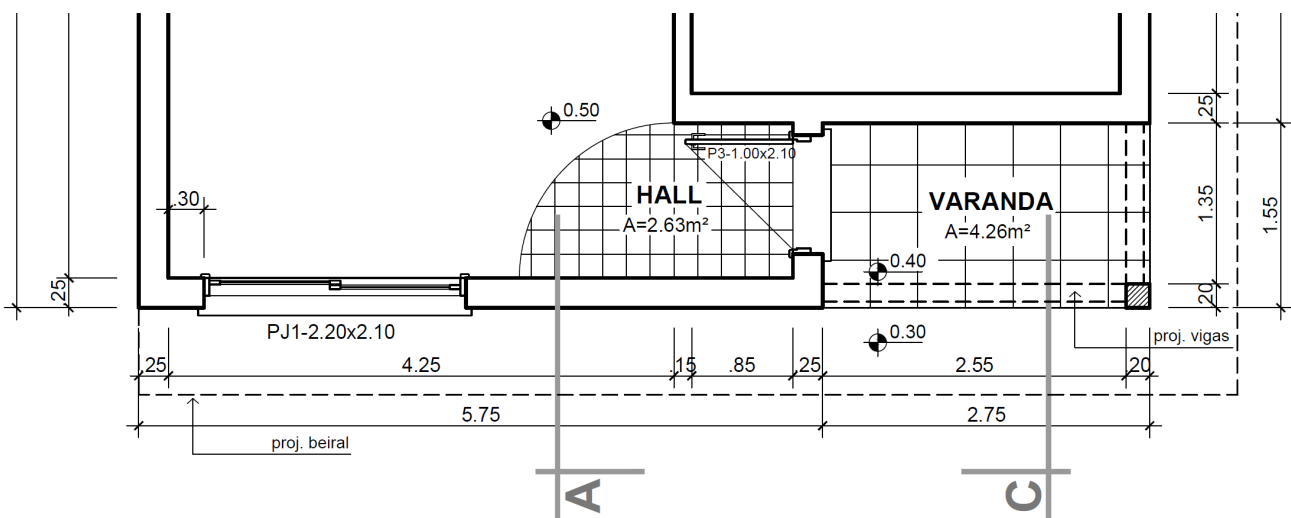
Etapas de representação da planta baixa: planos de cortes. Fonte: autor
